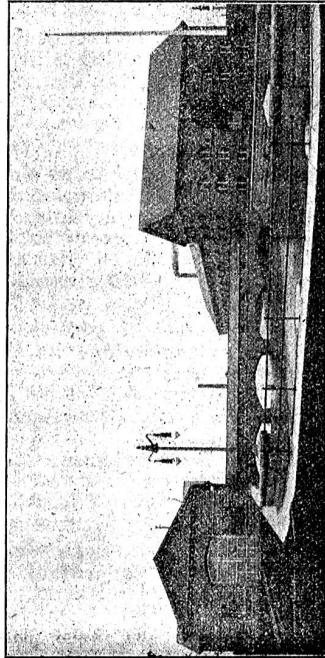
Der Wasserkanal mit den beiden Maschinenhäusern.
